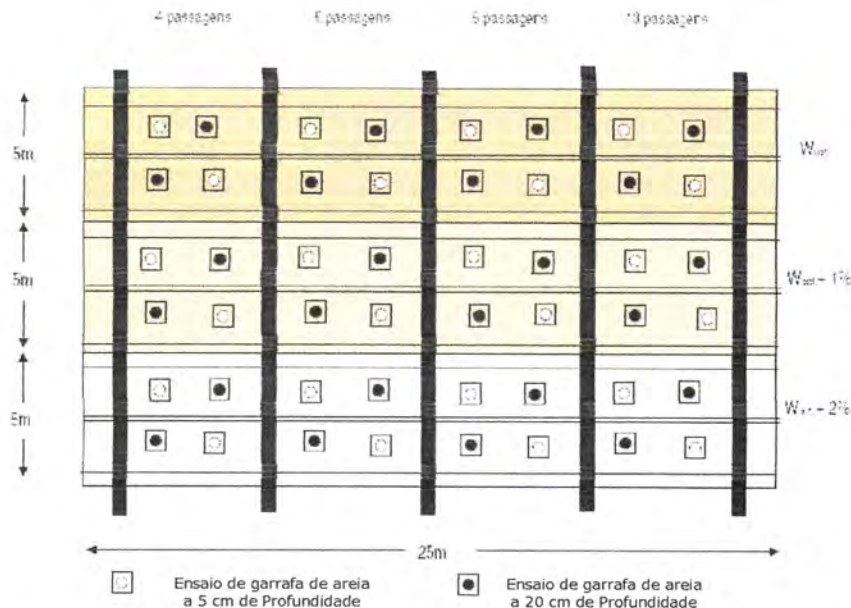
Localização em planta, dos ensaios para as camadas 0,3m e 0,4m de espessura
